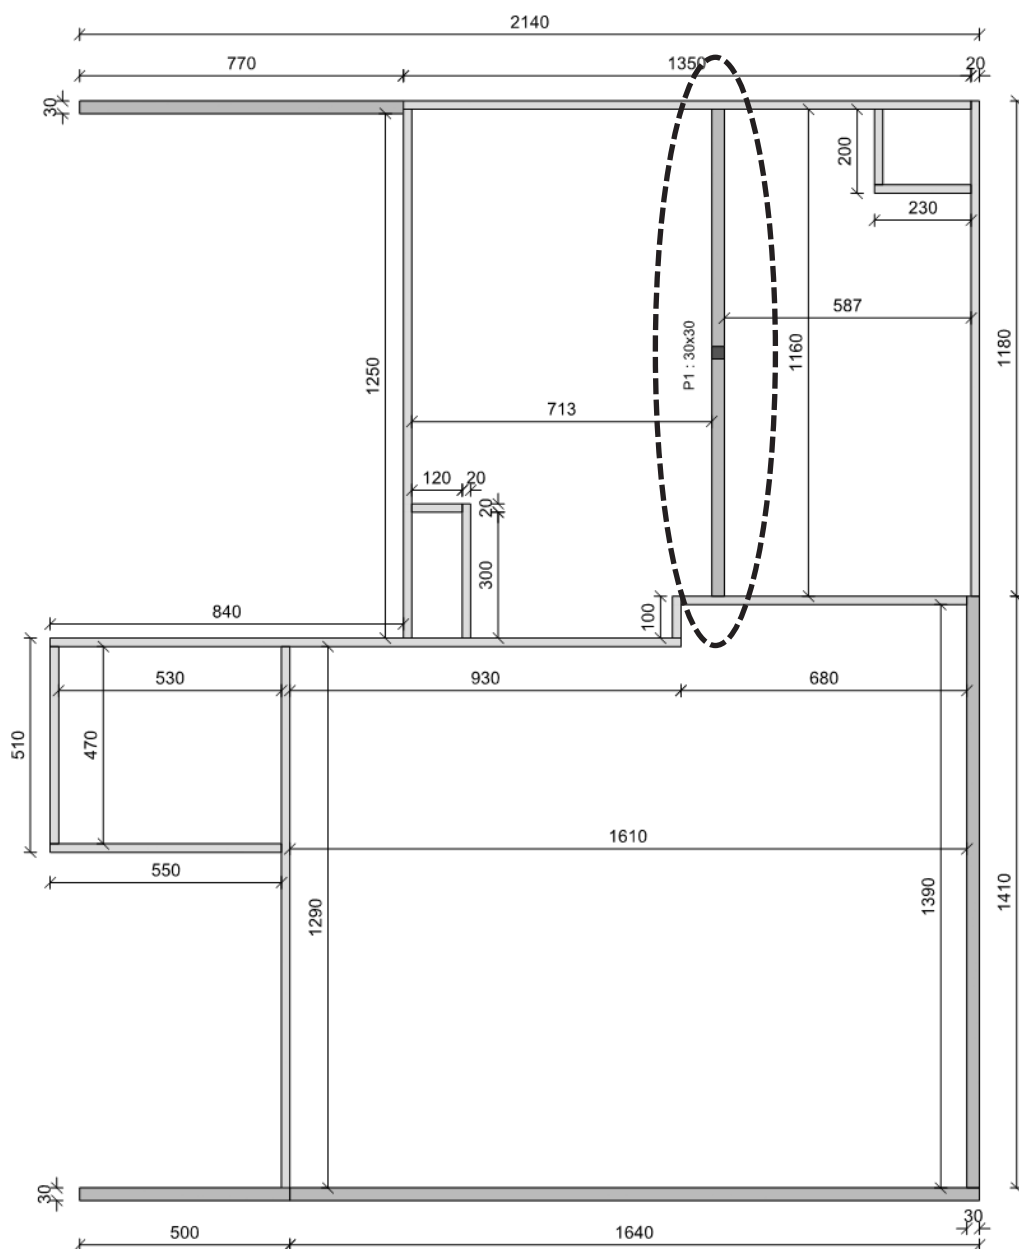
extrait simplifié du plan de coffrage du rez-de-chaussée avec identification de la poutre étudiée
